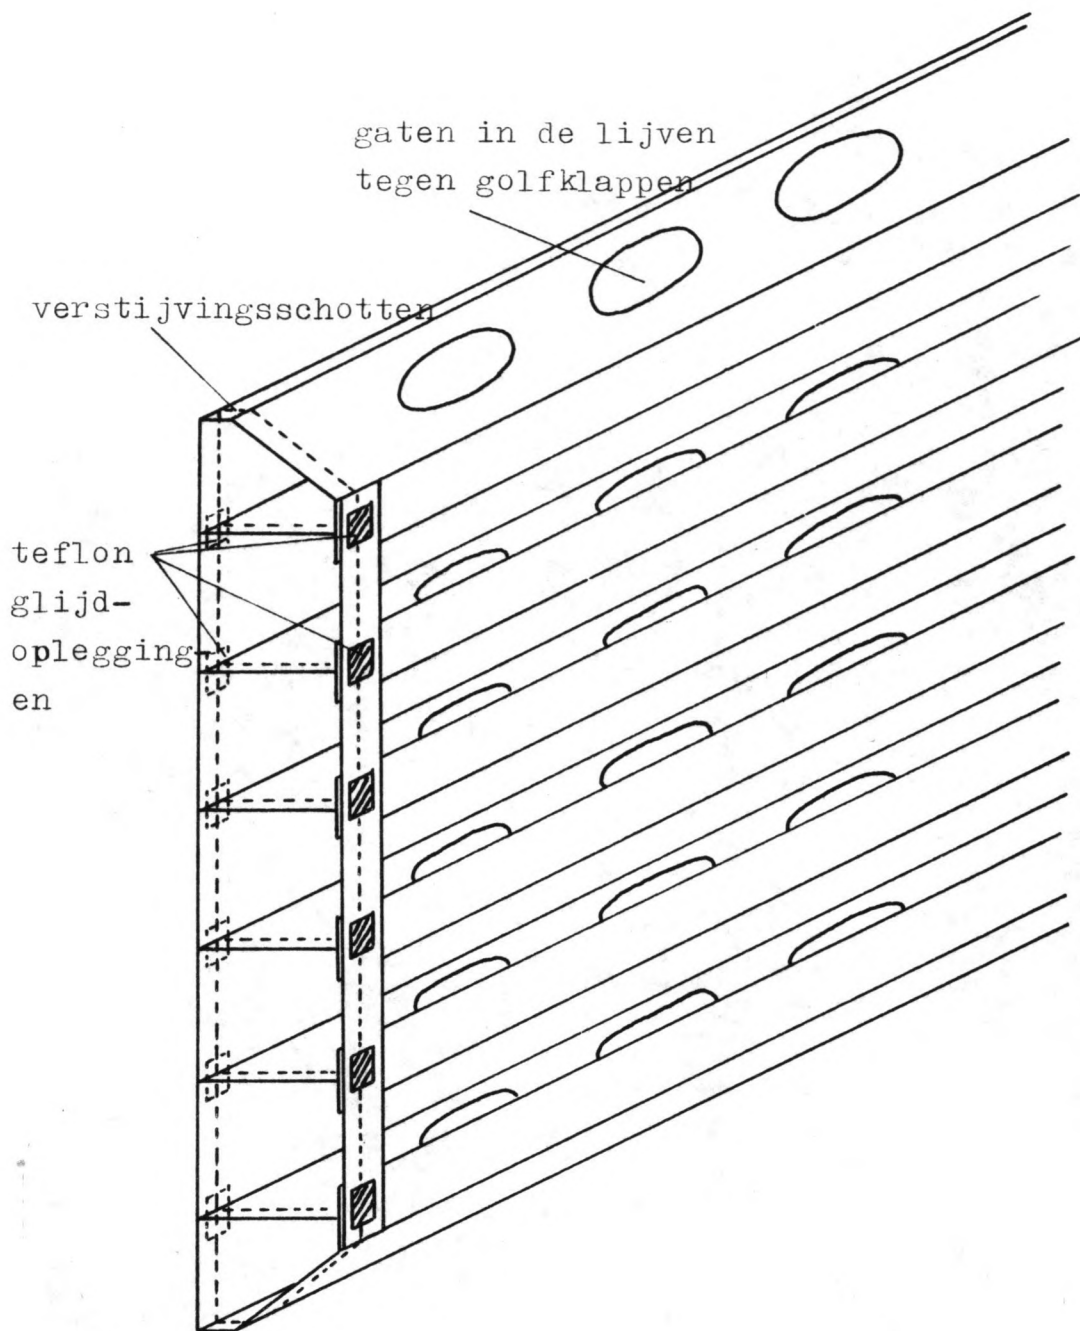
Detail oplegging van de schuif met teflon opleggingen en tussenschotten.
